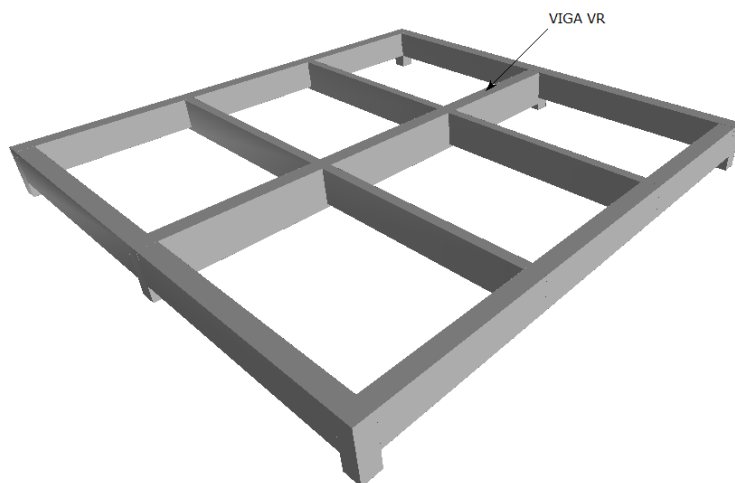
Forma do pavimento com a viga isostática biapoiada VR.
